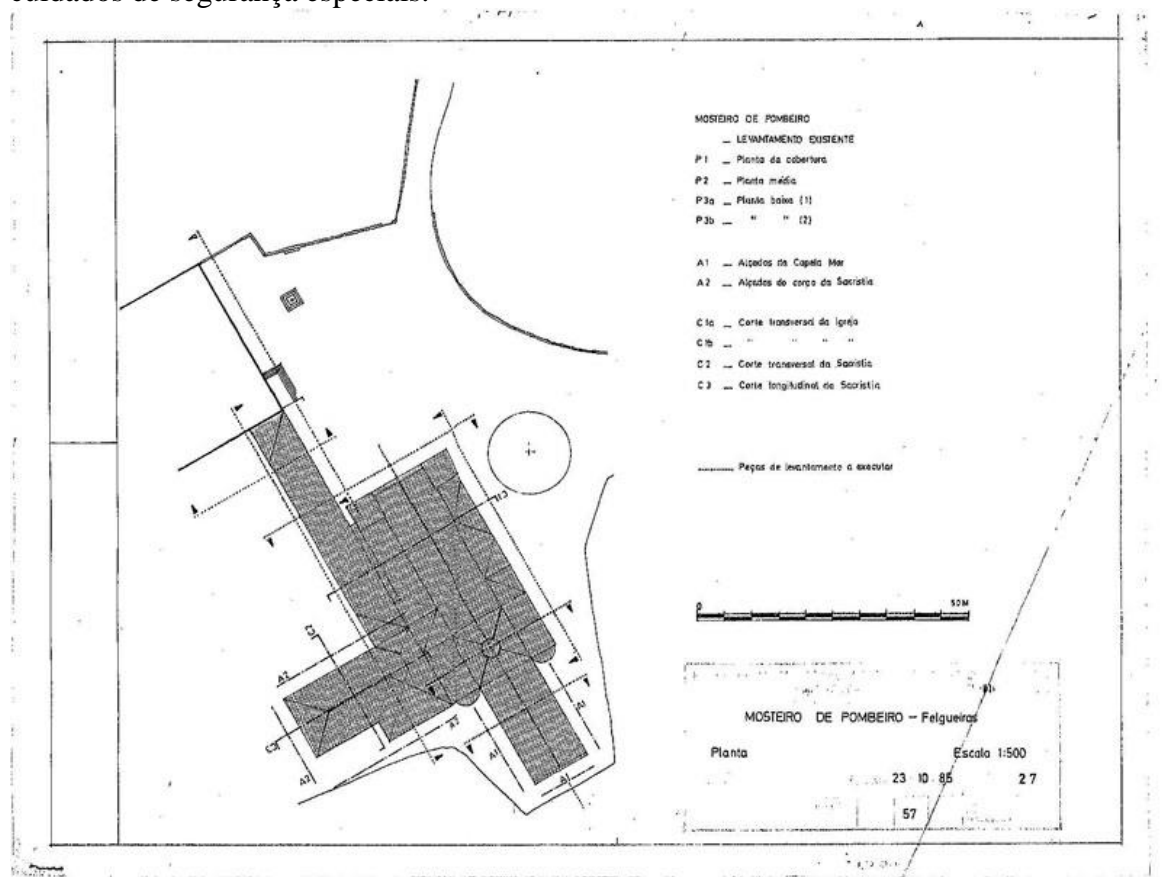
| Planta do Mosteiro Santa Maria de Pombeiro
